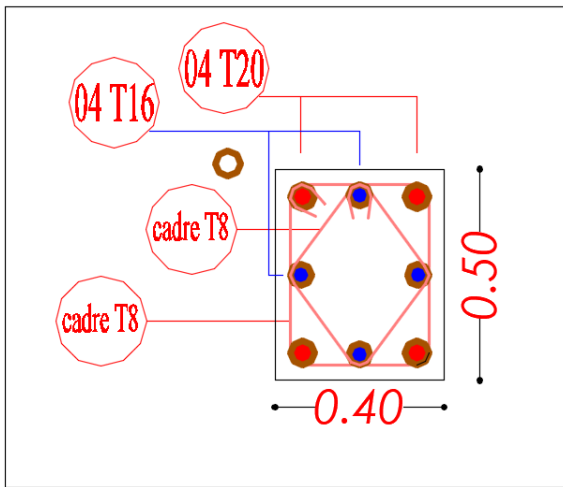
shéma ferrailage poteau(40× 50)cm²
